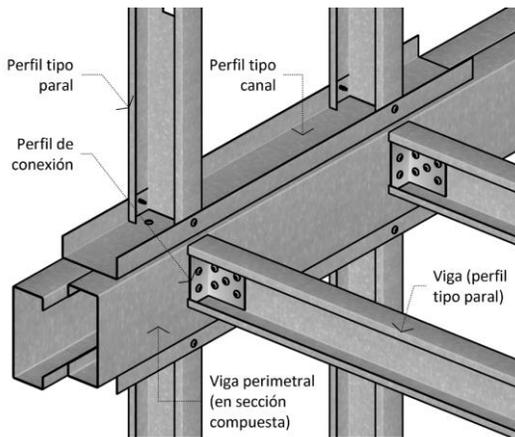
Entrepiso de sistema no lineal con viga o sección compuesta perimetral
